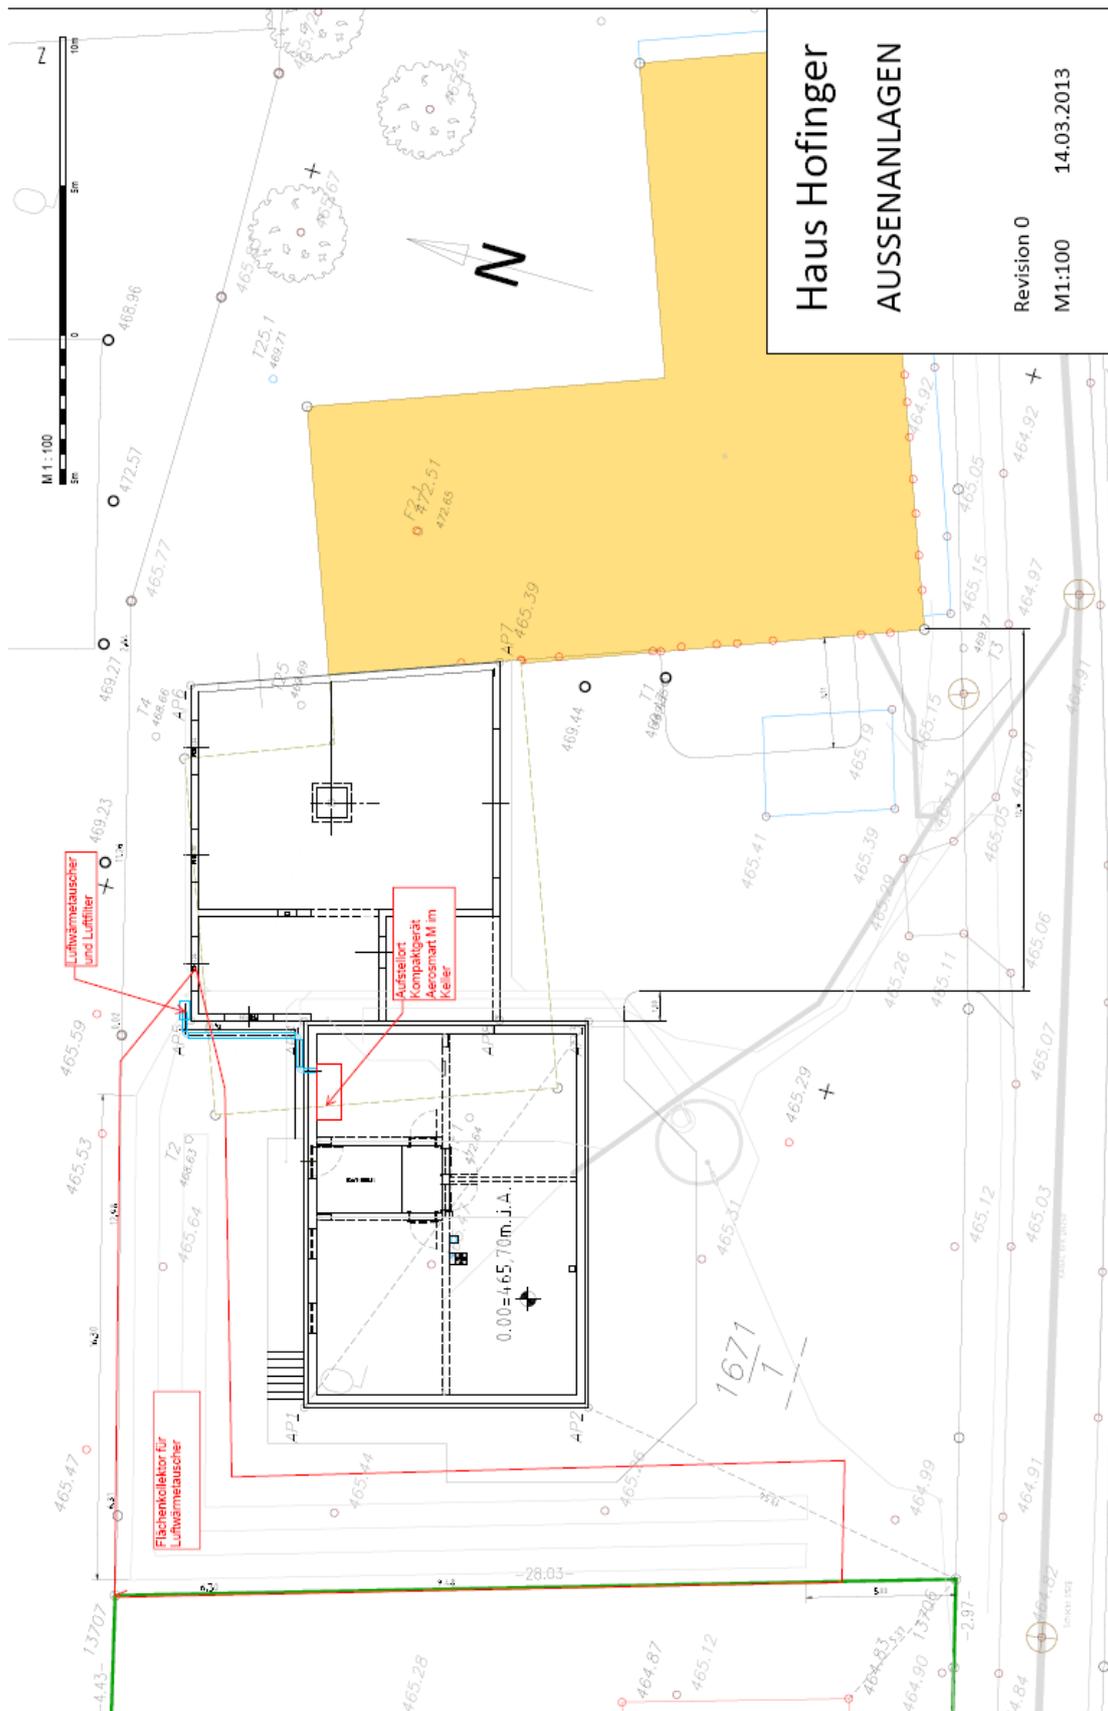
Gebäudeplan mit Außenanlage (Johann Hofinger)
